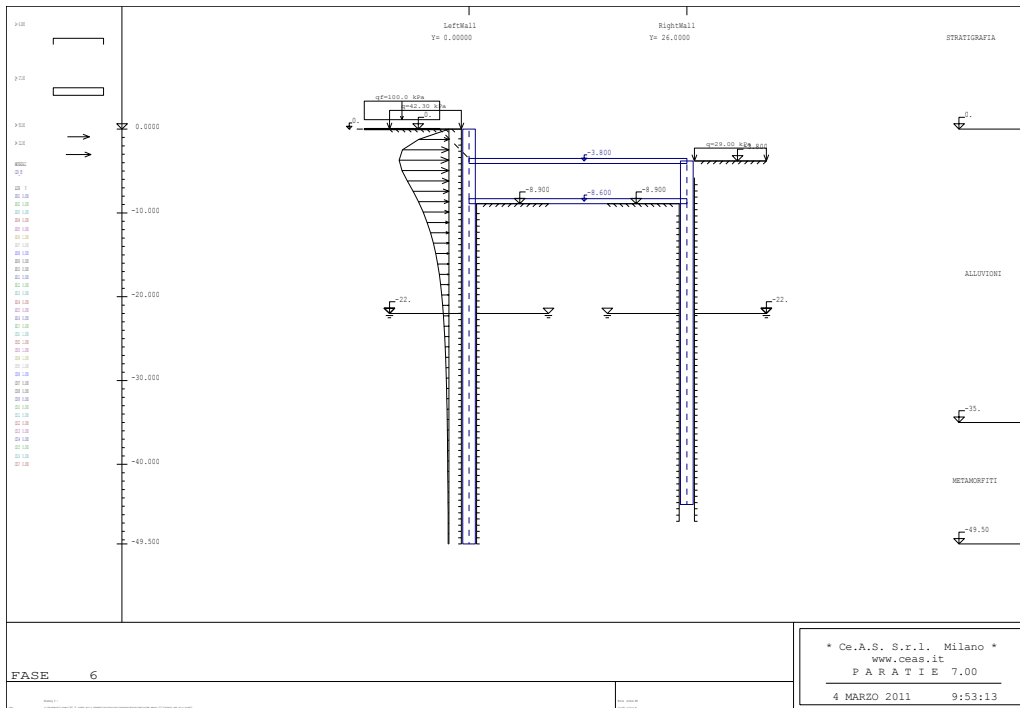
Fase 6: Getto Solaio +41.80m s.l.m
